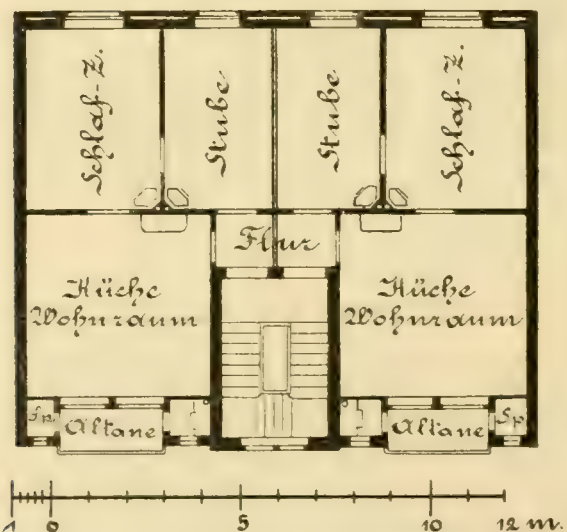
Plan eines Arbeiterwohnhauses. Grundriss der Obergeschosse.
